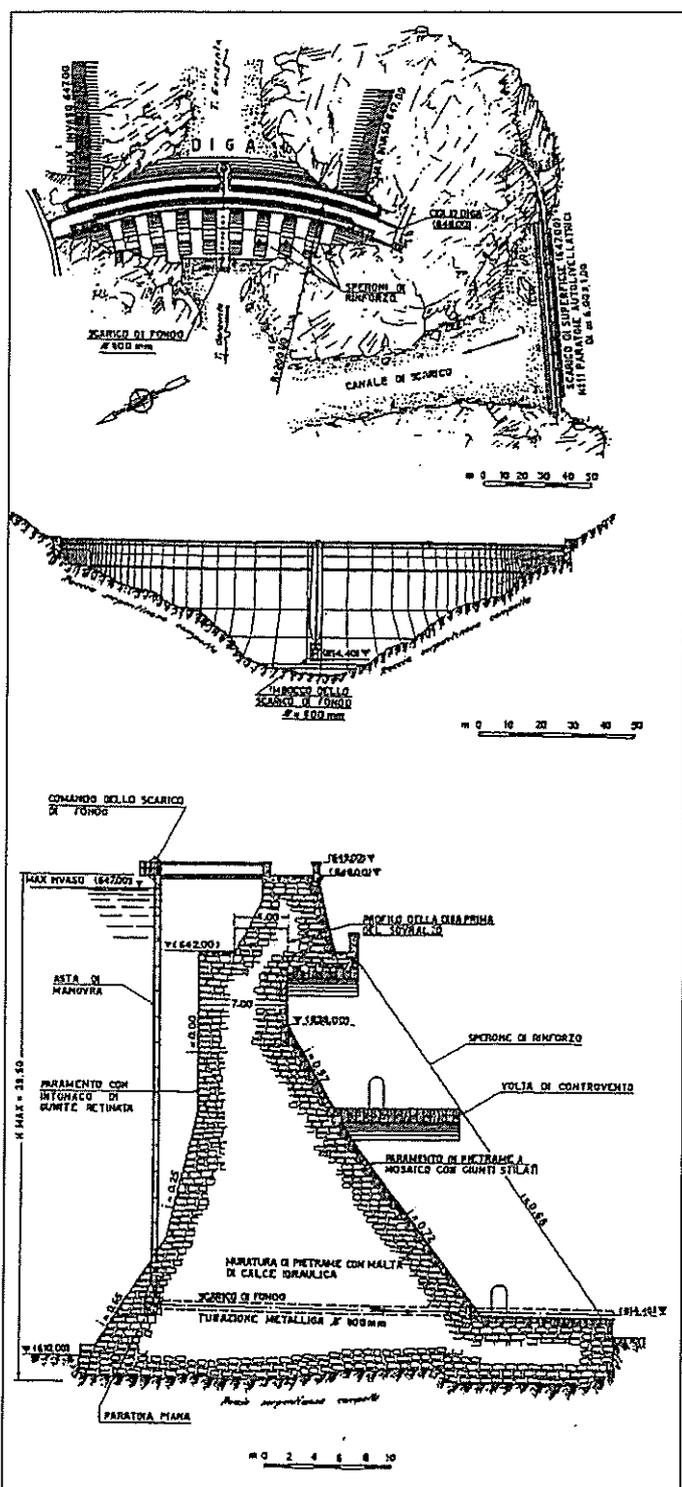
Diga Lago Lavezze: Planimetria - Vista da monte - Sezione tipo.
